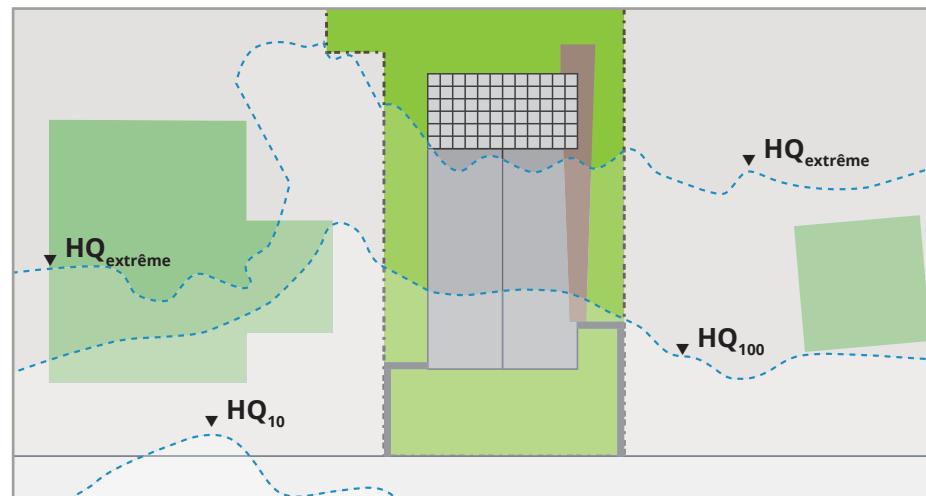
Vue en plan d'un bâtiment avec indication des zones inondables
